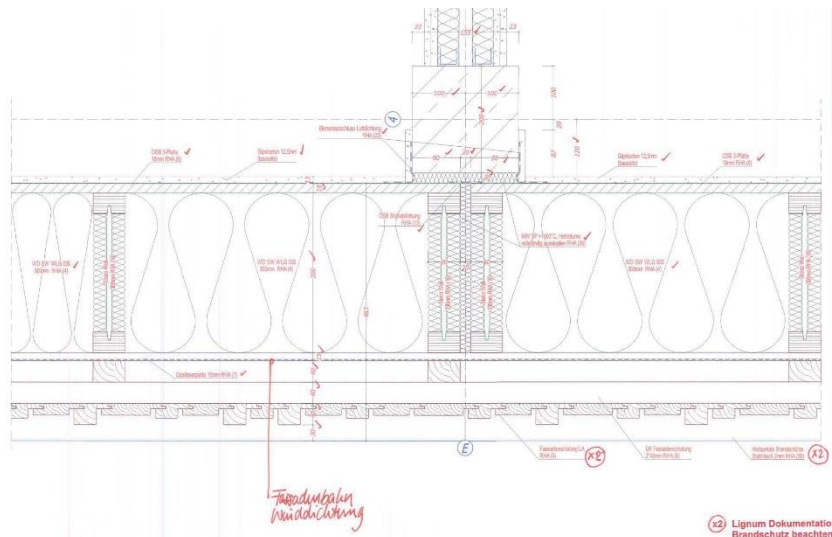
Detail Montageplanung horizontal, [Rubner Holzbau GmbH]
